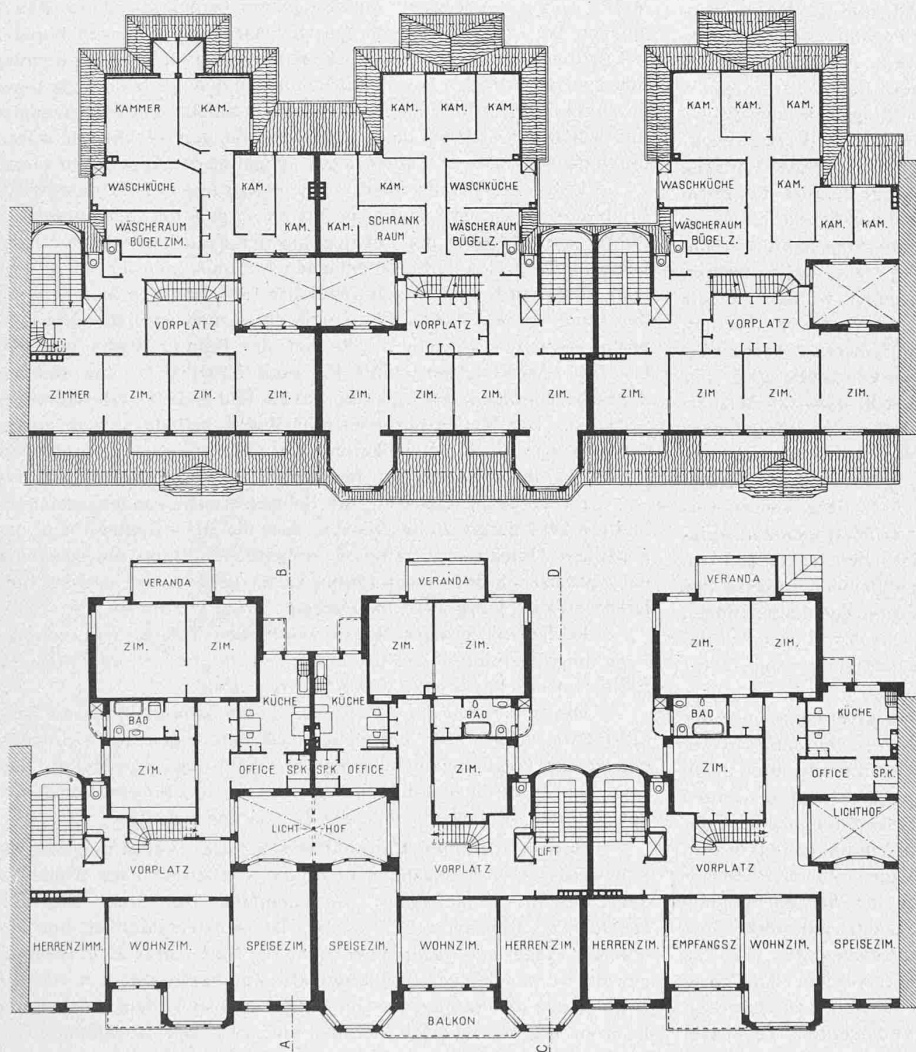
und 6. Grundrisse vom III. Obergeschoss und Dachgeschoss. — 1:400.
